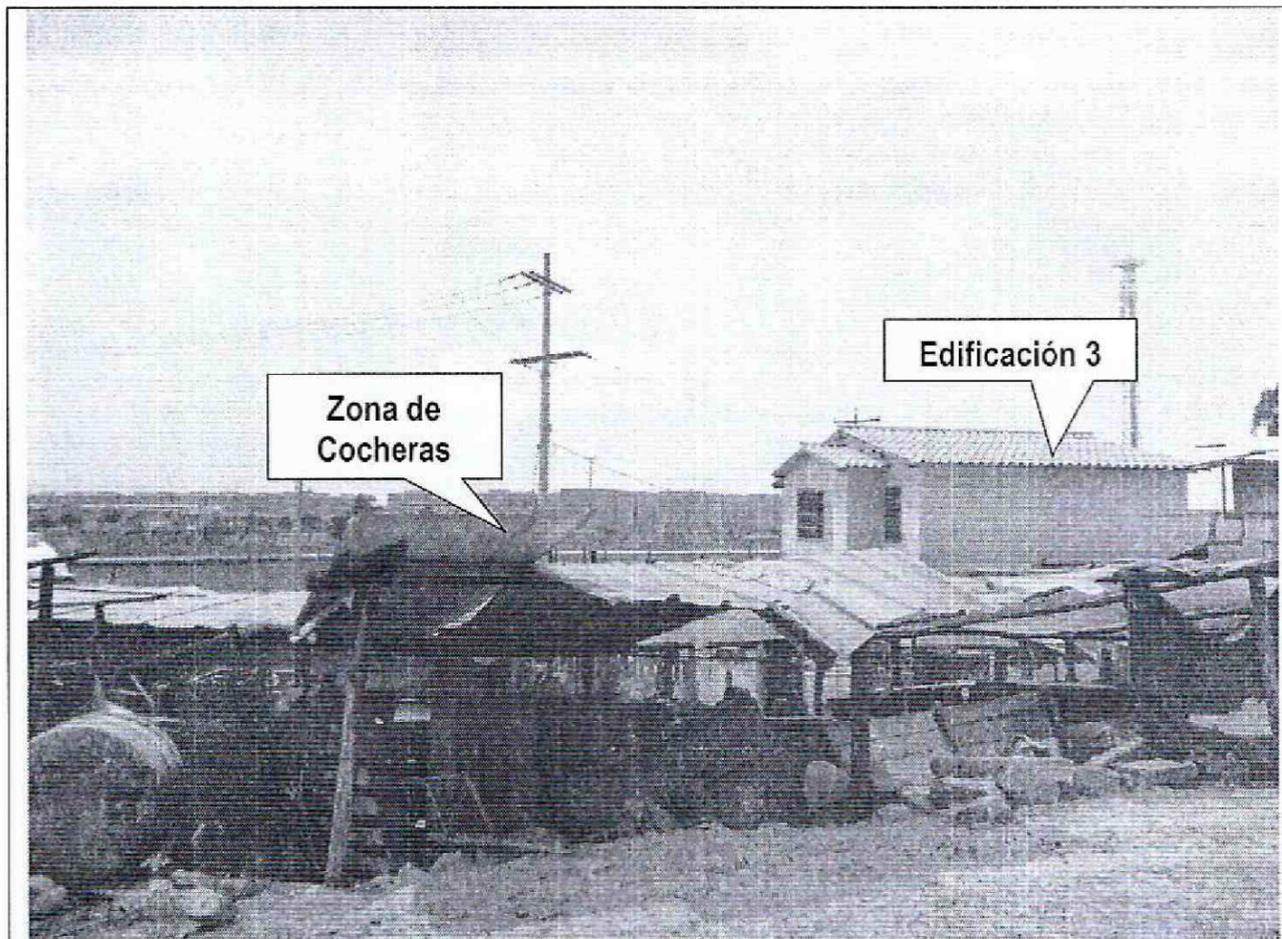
Vista frontal edificación 3 emplazada en el predio denominado "Las Marraneras"
